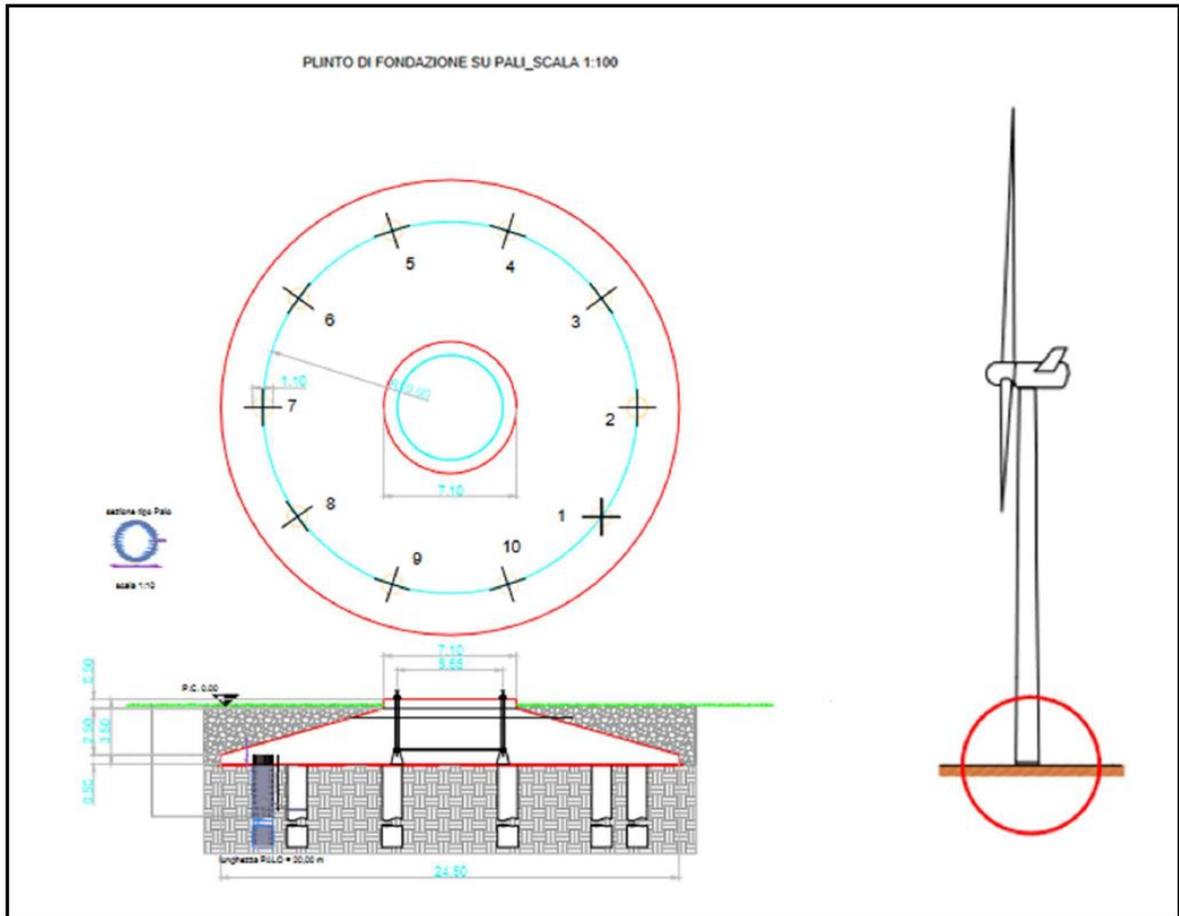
Fondazione - Dettaglio pianta e sezione fondazione
